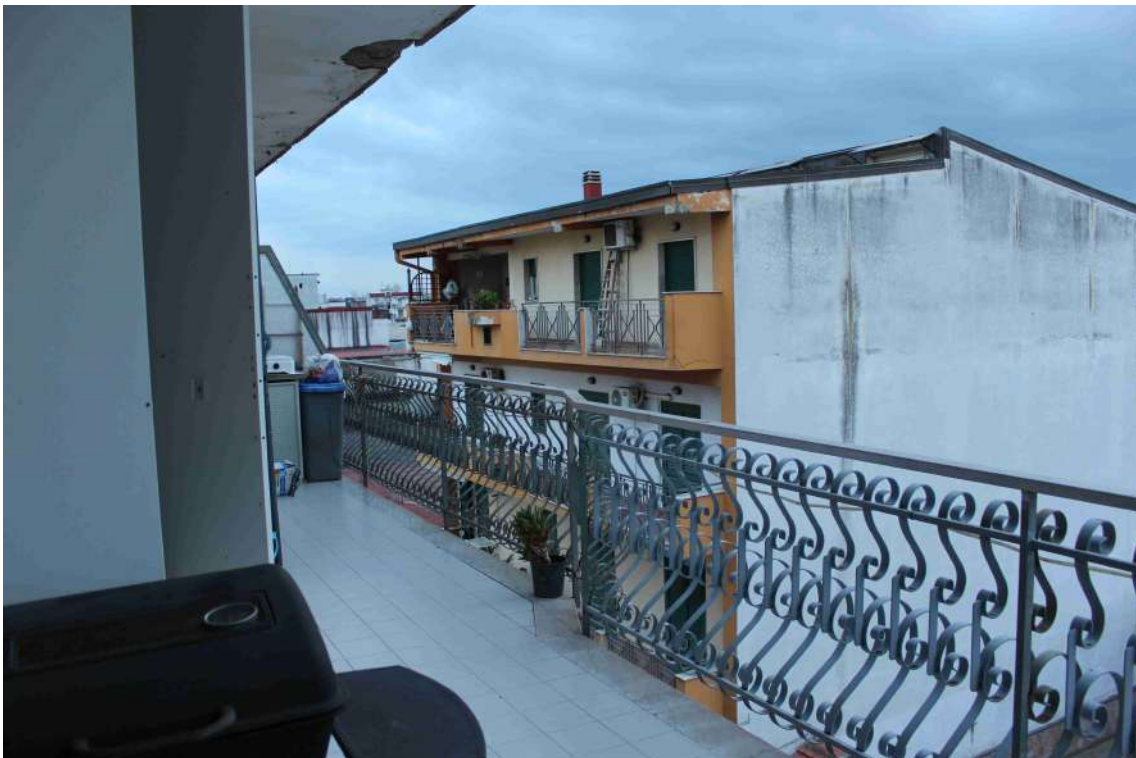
ringhiera in ferro del balcone posto sulla facciata principale del fabbricato.
